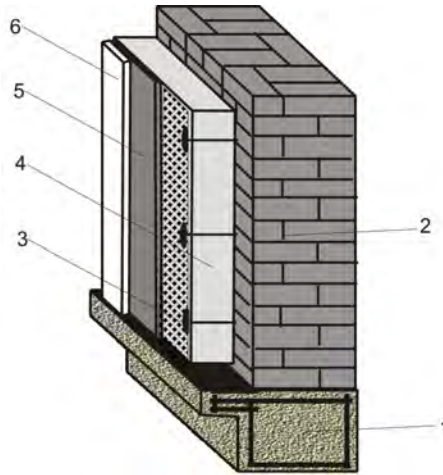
Фасад «мокрого типа»: 1 — монолитно-армированный пояс с устройством упора; 2 — полнотелый керамический кирпич, также это может быть силикатный кирпич; 3 — дюбели для крепления фасадной теплоизоляции, расход 6–7 шт./м²; 4 — теплоизоляционный слой 100–120 мм, в качестве которого можно применить минераловатные плиты или плиты из вспененного полистирола; 5 — слой армирующей шпаклевки с армирующей сеткой; 6 — декоративная штукатурка, клинкерная плитка, облицовочный камень
